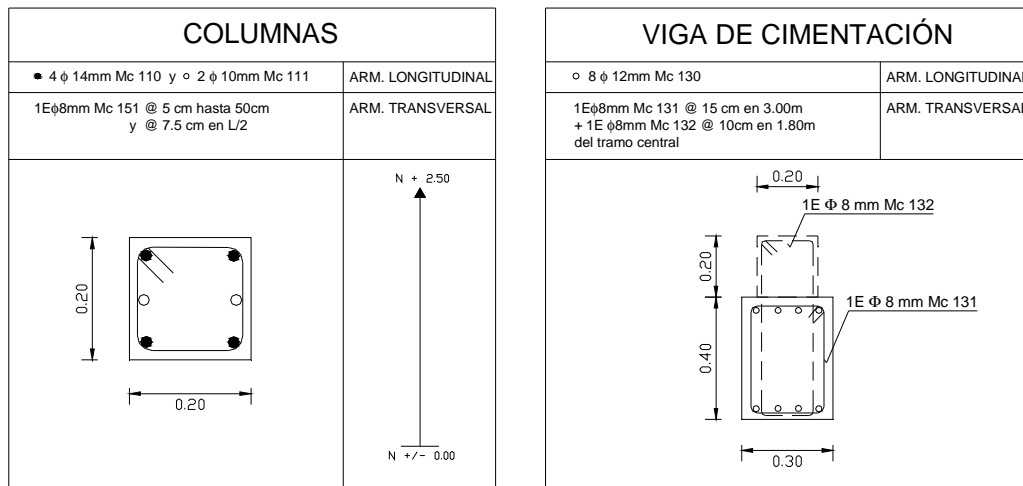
Diseño estructural del Pórtico Tipo de H.A. Columnas y viga de cimentación
